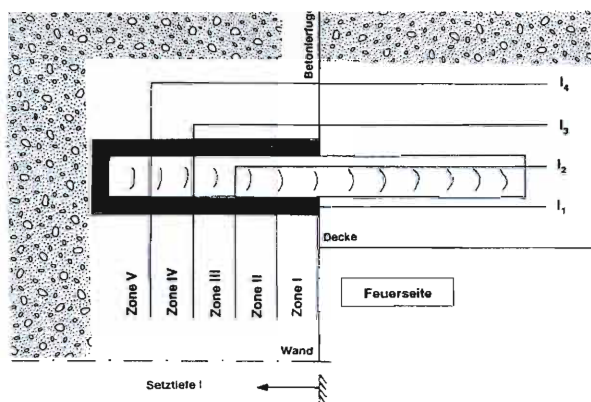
Schematische Darstellung der Bewehrungsanschlussvariante „Verankerung“
